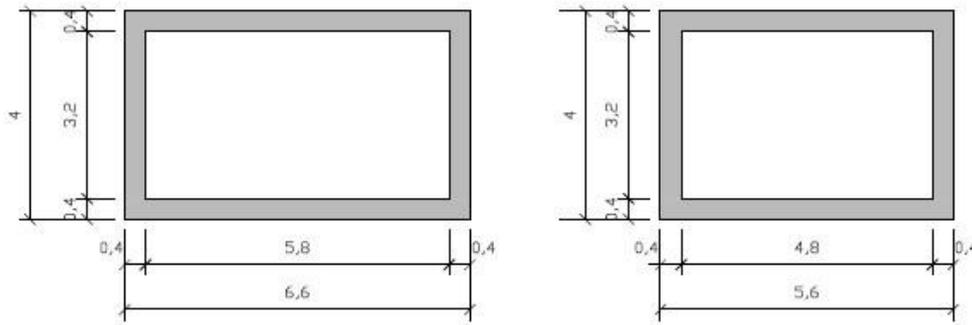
Sección de las pilas del Puente 2, en su parte inferior (izqda.) y en el centro de la pila (dcha.).
